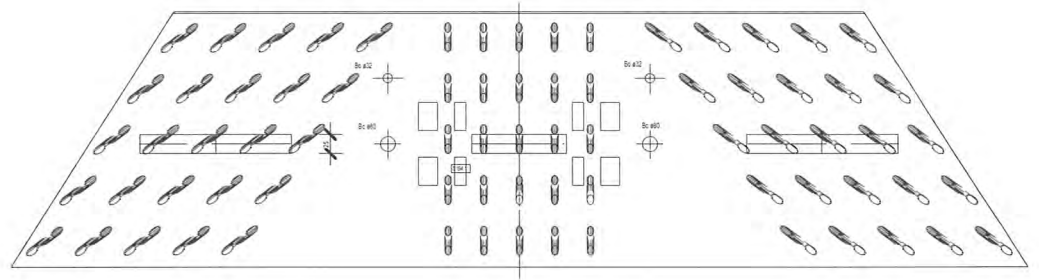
Stahlplatte des Firstgelenks mit Bohrungen für die Gewindestangen
